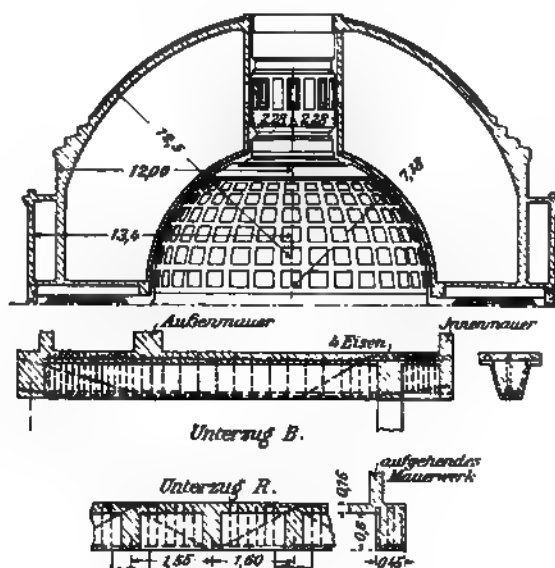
Kapitol in San Juan, Porto Rico. Grundriß und Schnitt der Doppelkuppel.
